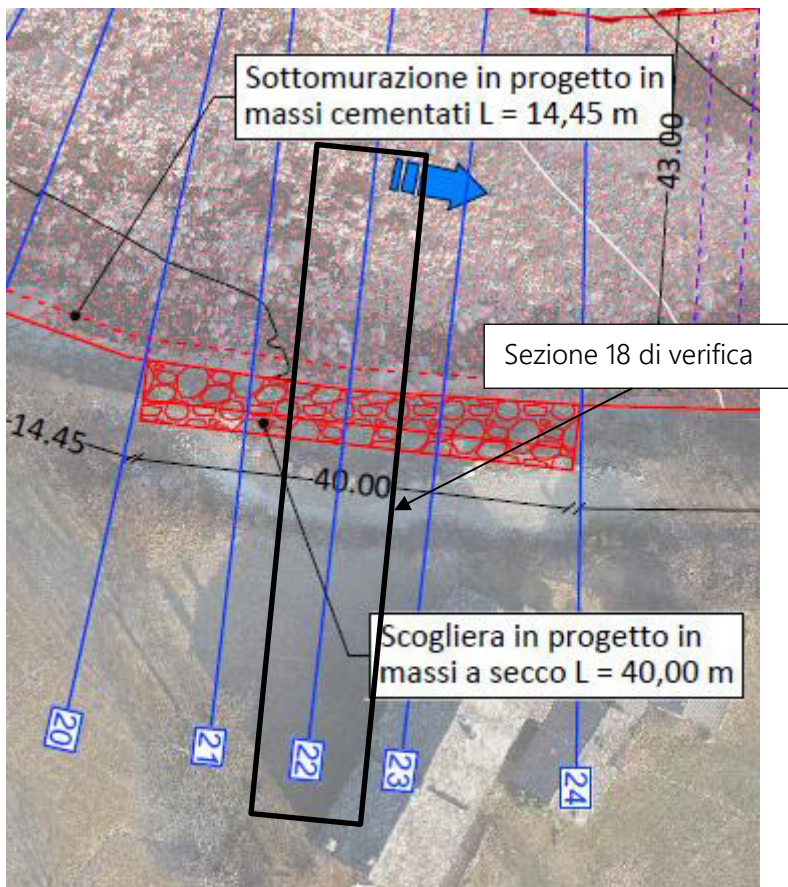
Tav. 03.3_ Planimetria di progetto – Sezione di verifica
